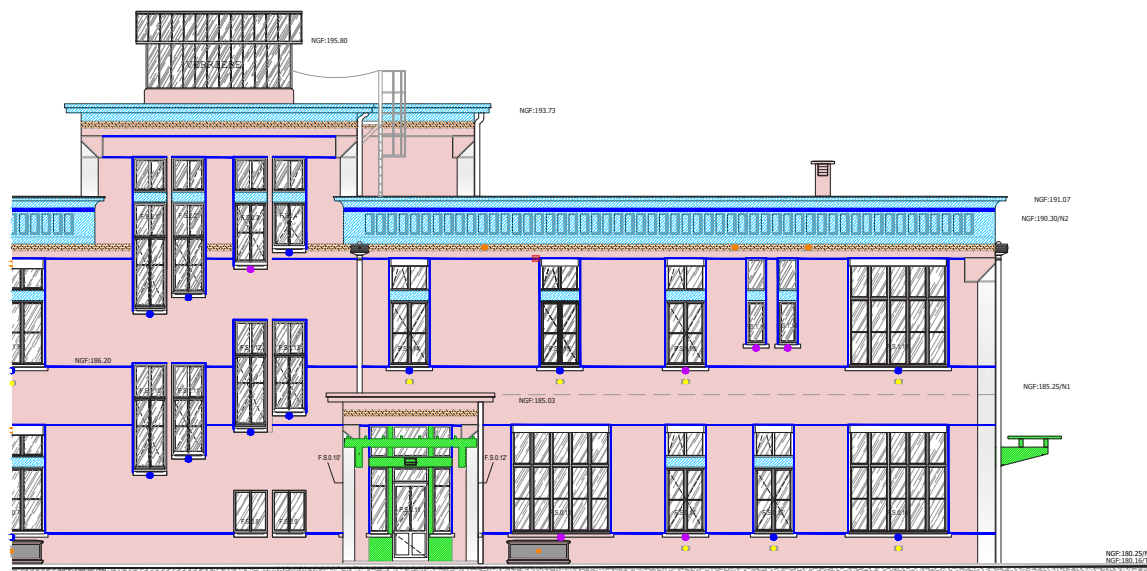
État projeté (APD) du lot Gros-œuvre - maçonnerie - pierre de taille, coupe-élévation sud, pavillon A, Agence Goutal, 2024.
